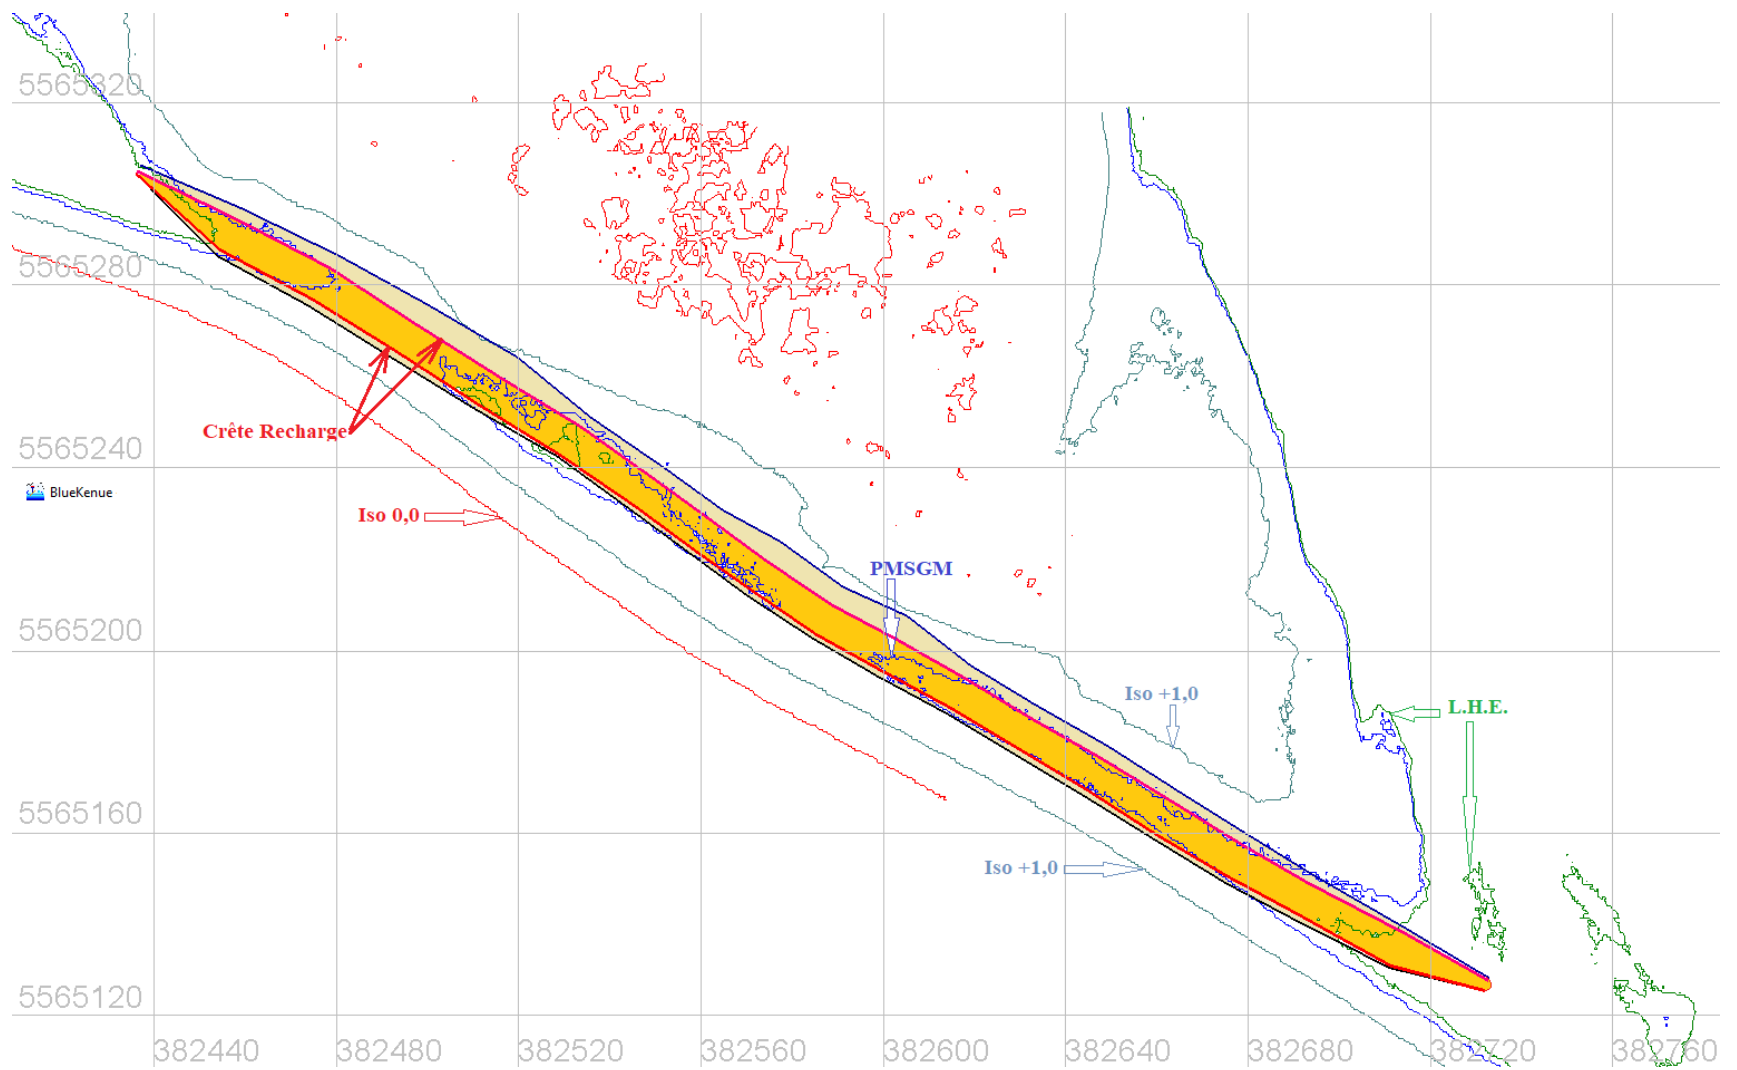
Vue en plan de la recharge de plage (à l'équilibre) proposée pour la façade ouest du territoire - ITUM
